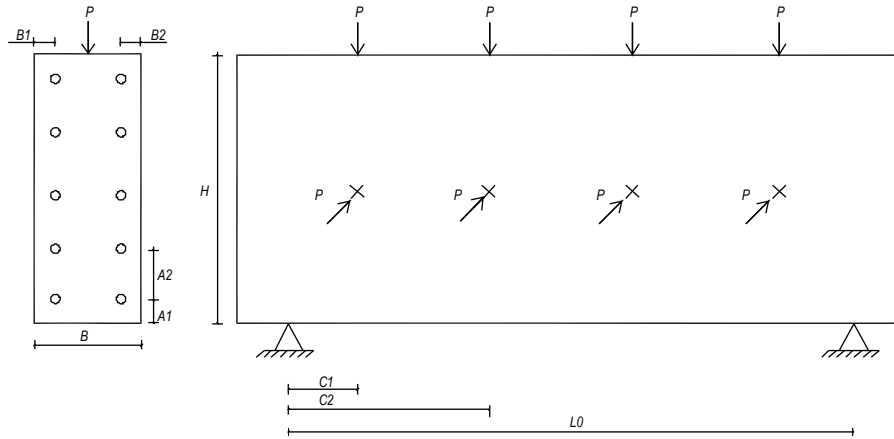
Схема испытания стеновых панелей на вертикальную и горизонтальную нагрузки
